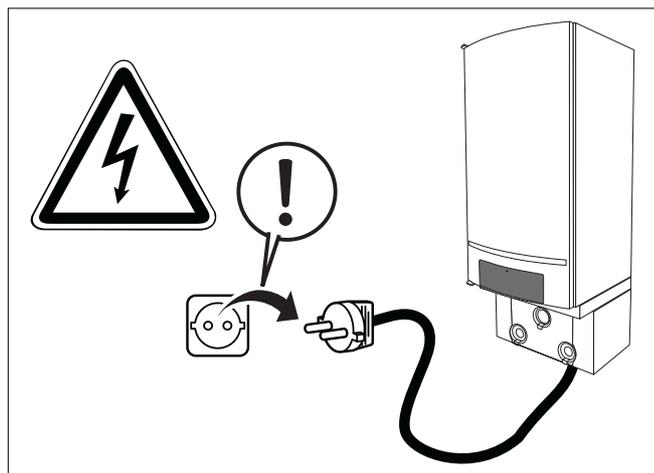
Togliere la corrente dall'impianto di riscaldamento
